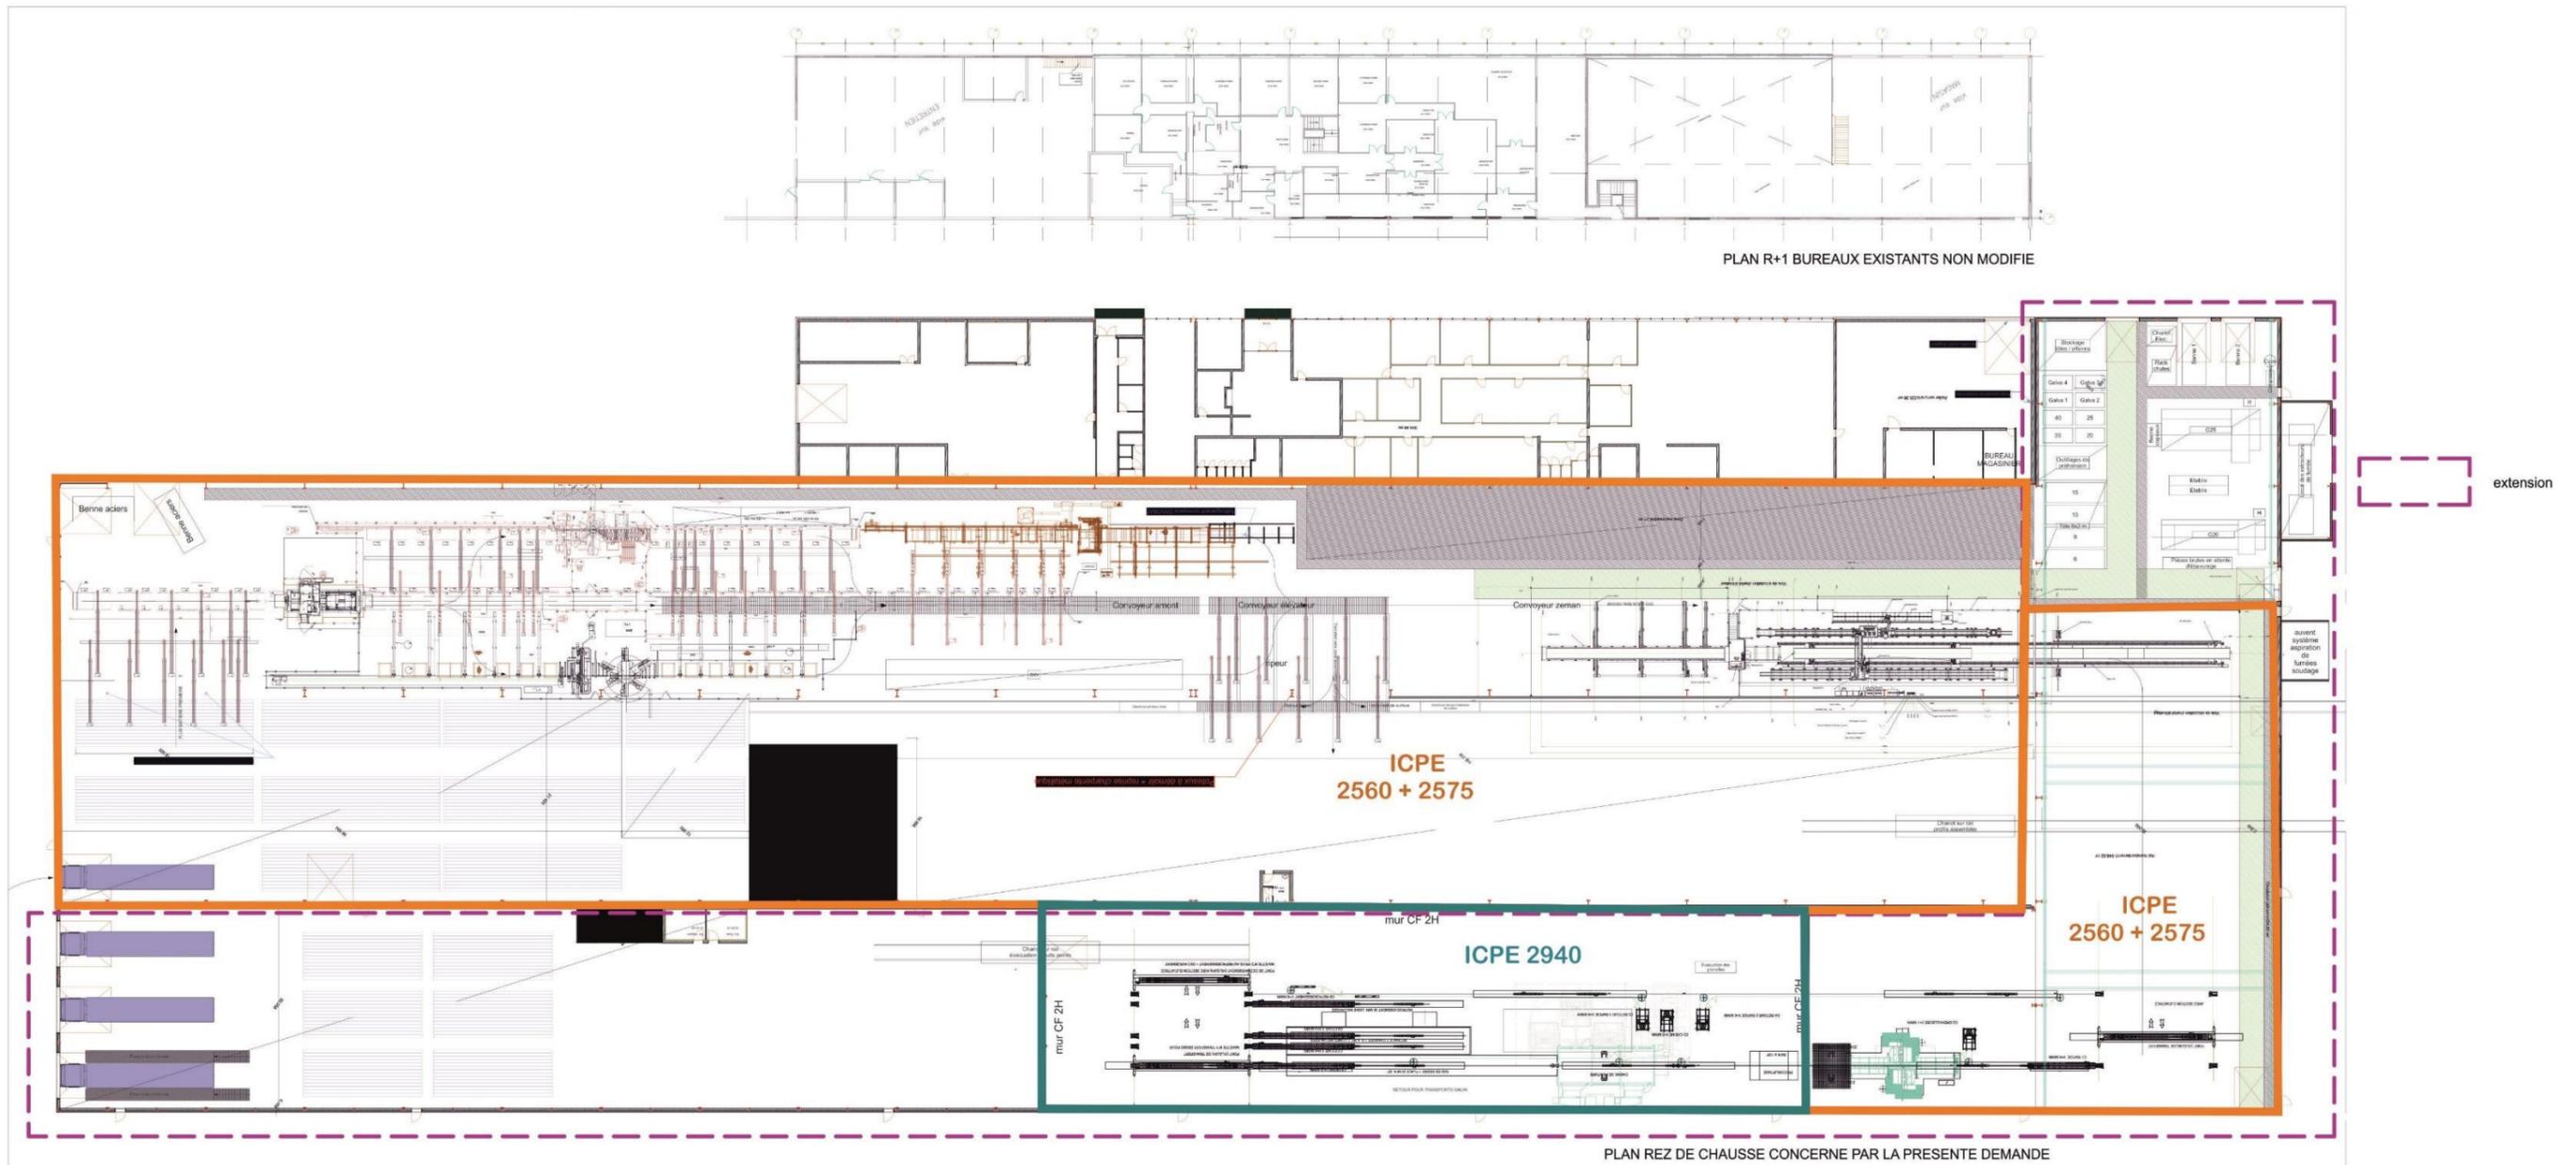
Localisation des installations ICPE sur le site projeté de VILQUIN
